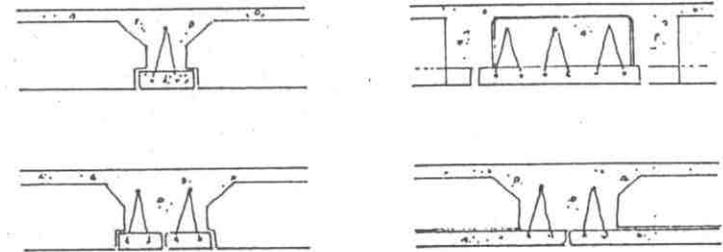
Viguetas, nervios dobles, vigas y prelosas prefabricadas
